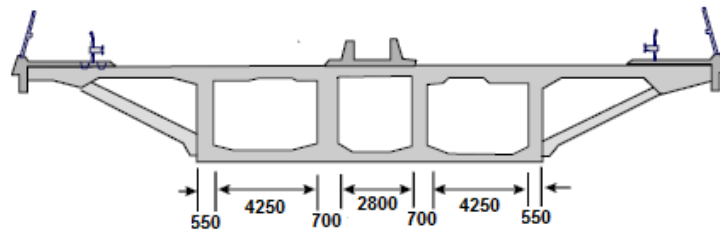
Secção transversal em caixão do tipo celular da ponte Wesel, Alemanha (Hanswille, G *et al* 2007).
